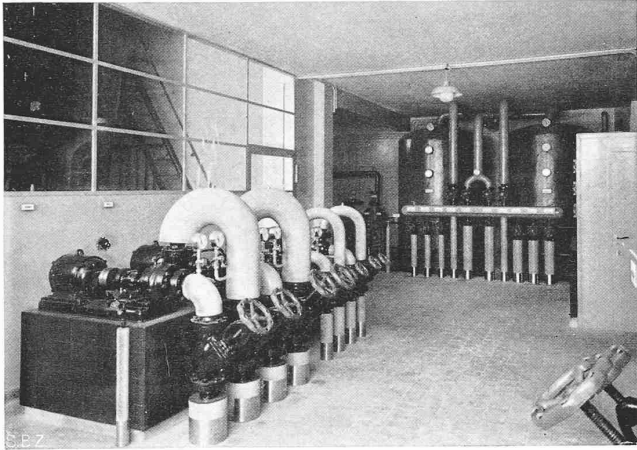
Sole-Umlaufpumpen, rechts hinten 2 × 7000 l Boiler
